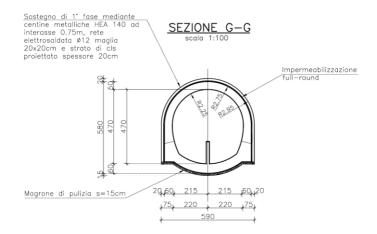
Esempio di opere di contenimento degli scavi per cabina tecnica e pozzo verticale Sezione trasversale.
